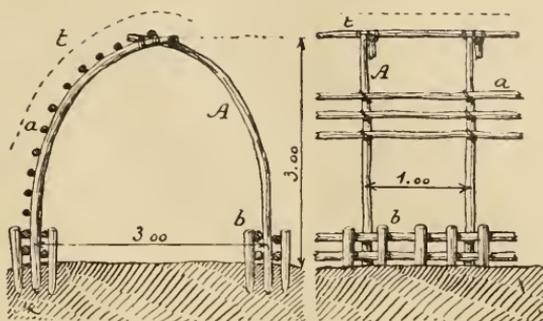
Coupe en travers et élévation d'un gourbi.
